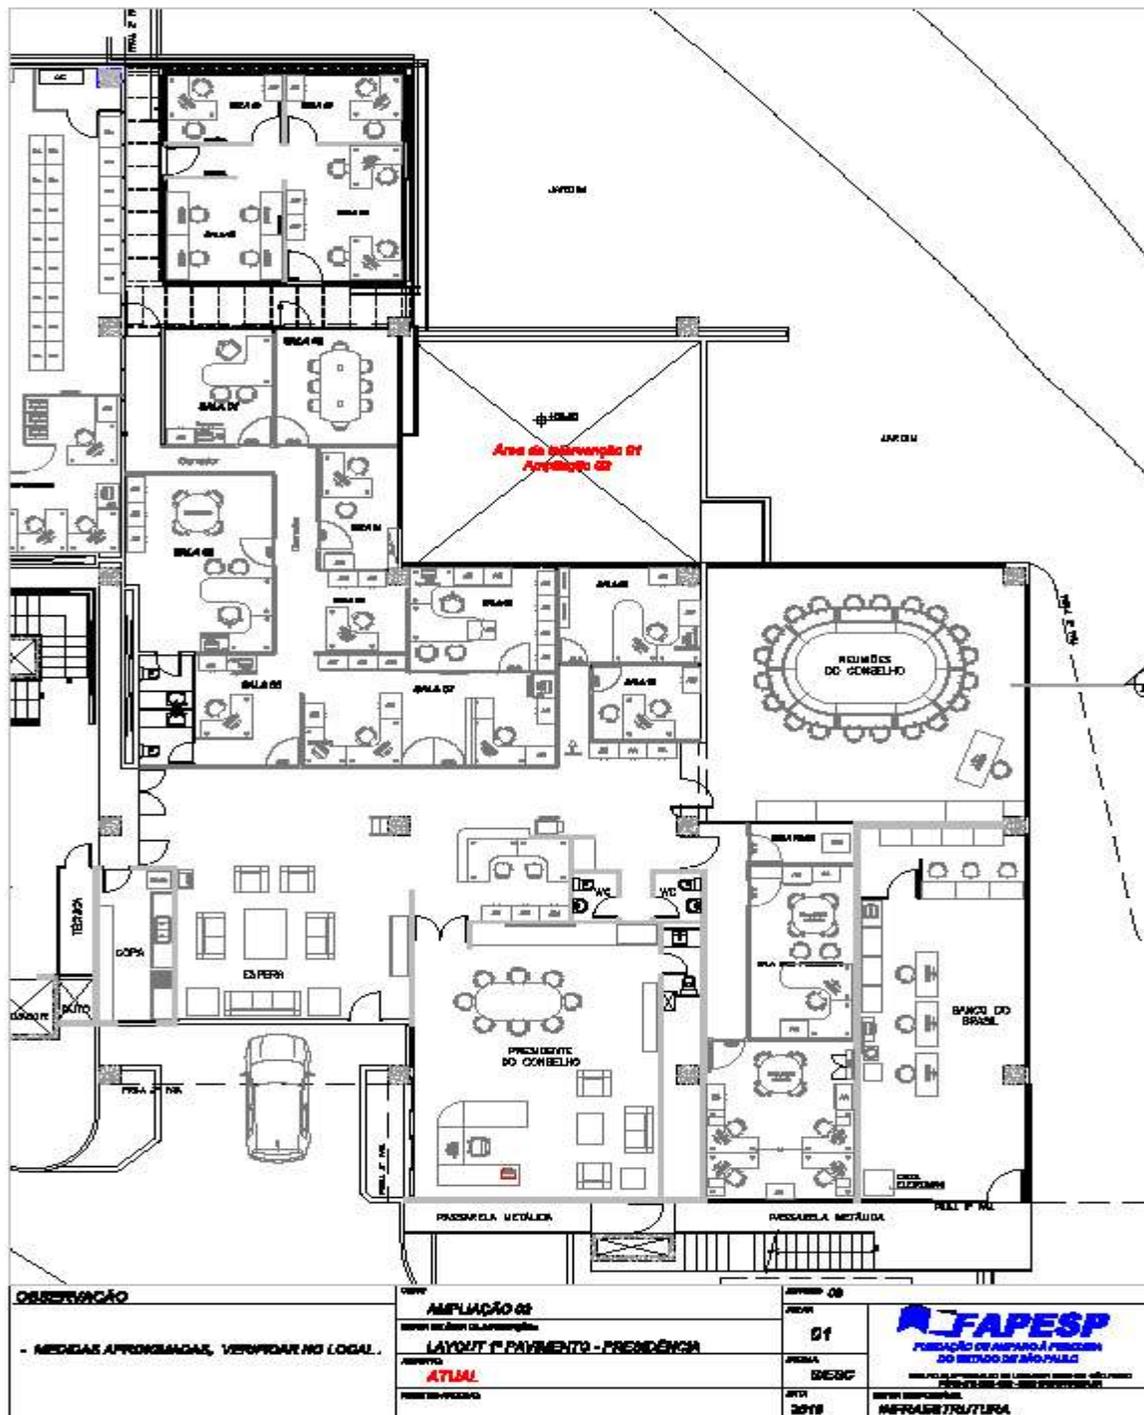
Planta Atual – Setor Presidência – 1º Pav.
